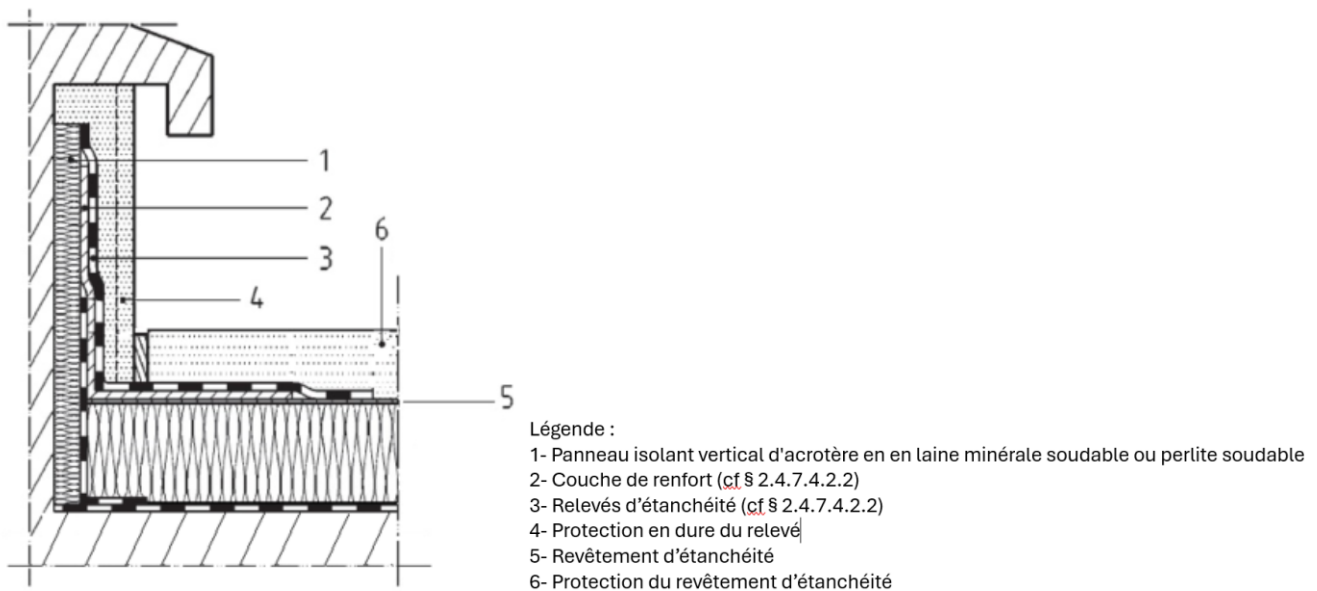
Revêtement sous protection dalles sur plots sur élément porteur en maçonnerie
